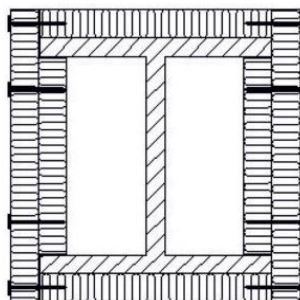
Схема устройства покрытия из плит минераловатных на балках [1]
